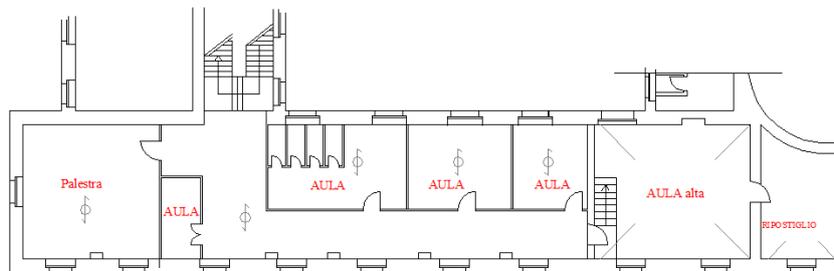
Rilievo del secondo piano aggiornato e corretto (ALLEGATO 5)
